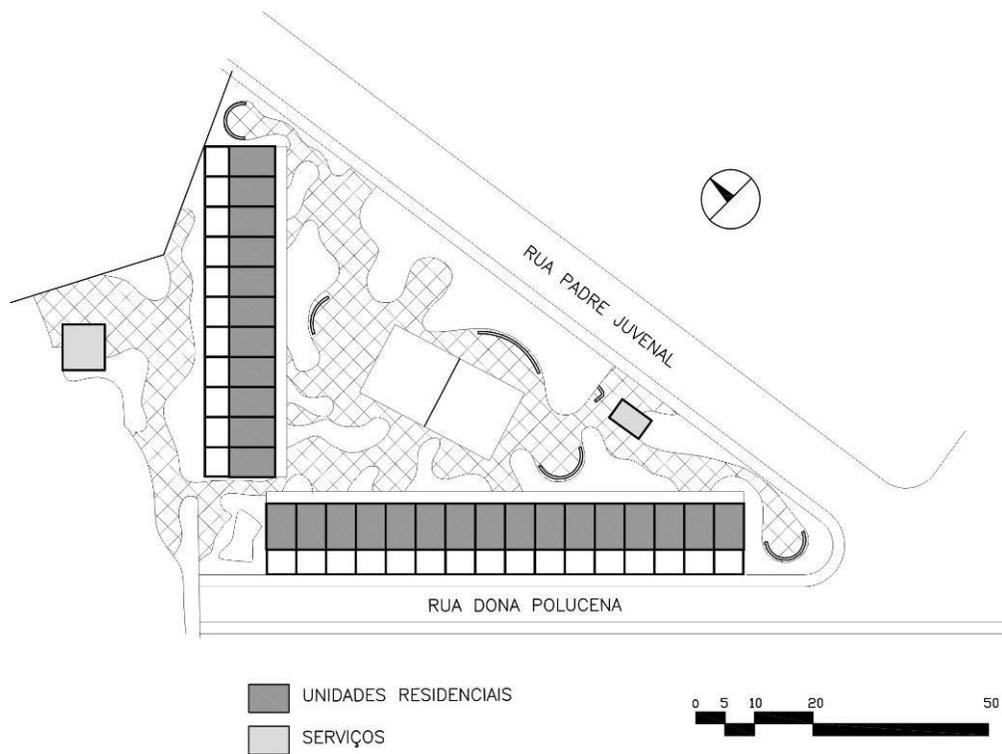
Plantas de situação do Conjunto Residencial Paquetá.
